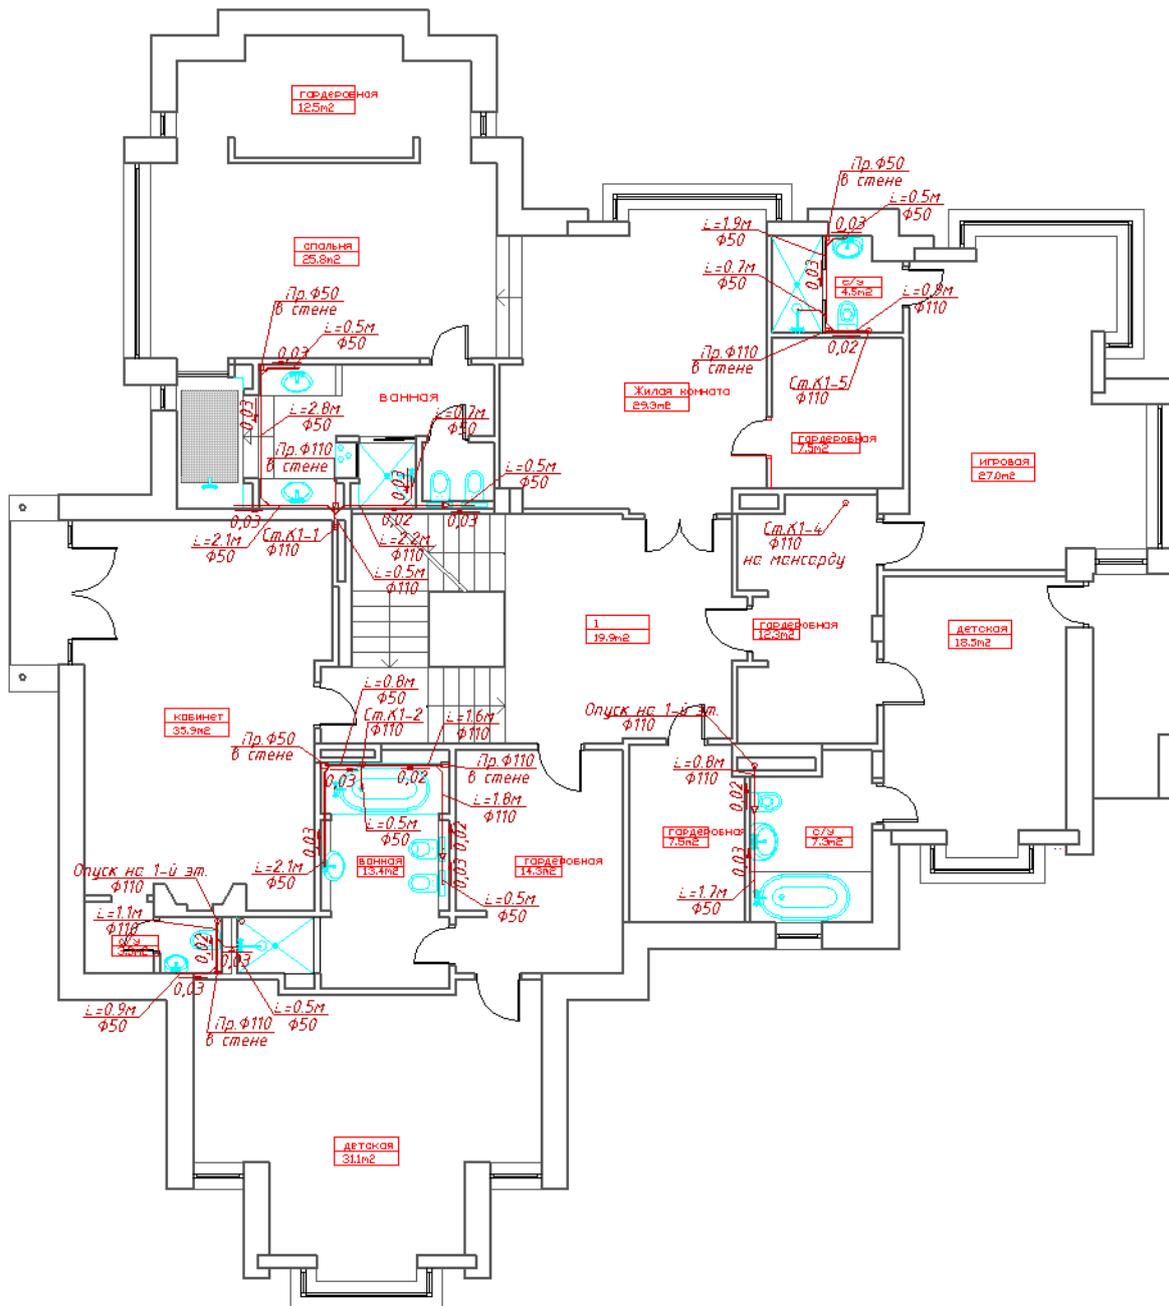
Эскиз плана этажа с нанесением оборудования и сетей холодного и горячего водоснабжения, водоотведения
